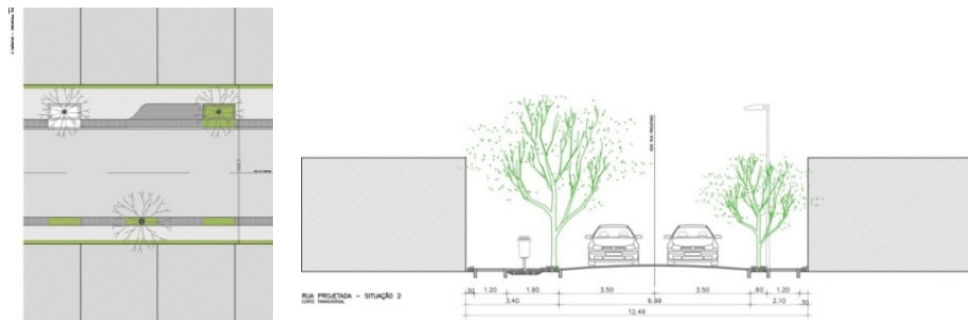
Planta da situação 2, eixo da via 12,50 m
